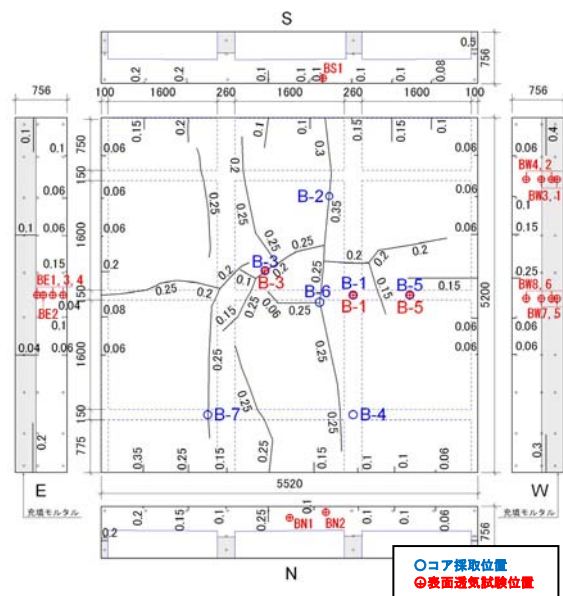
B 面の表面ひび割れ進展図とコア採取位置
